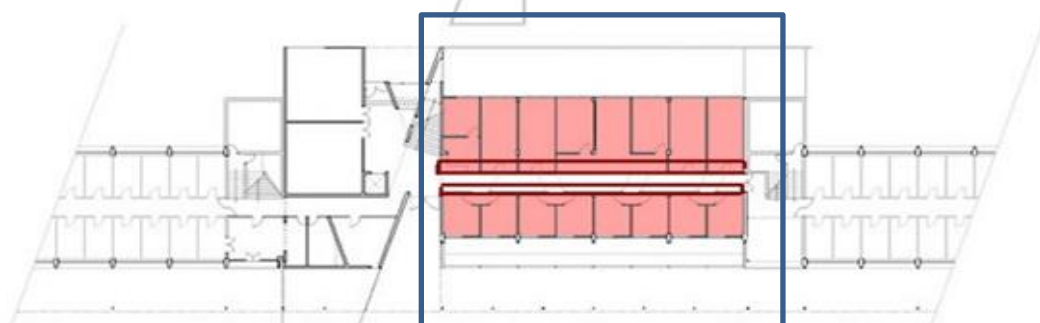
Alejandro Aravena facultad de matemáticas chile. Web entrevista Aravena-2006 plano planta 2 piso.-
